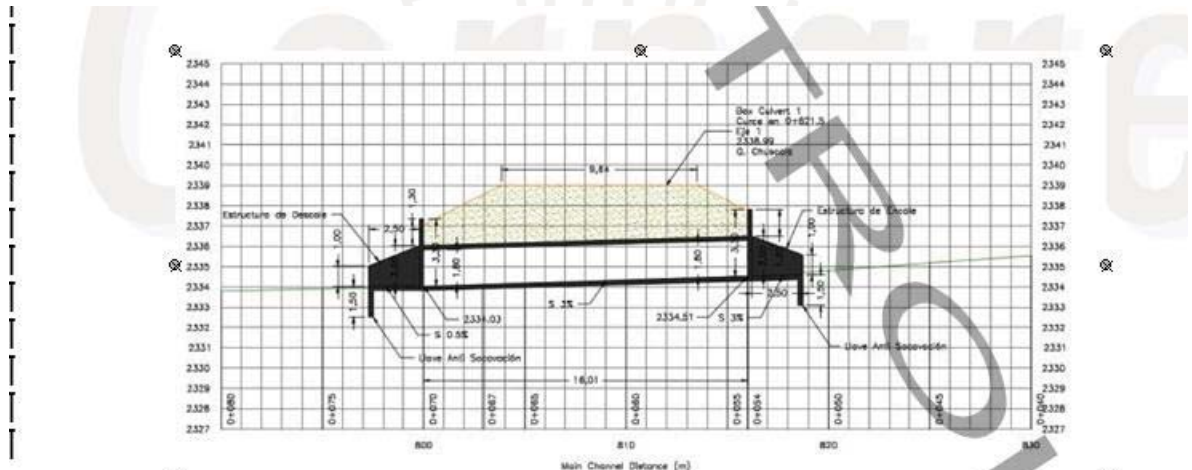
Perfil del Box Culvert (Obra 2) sobre la quebrada Chuscala
